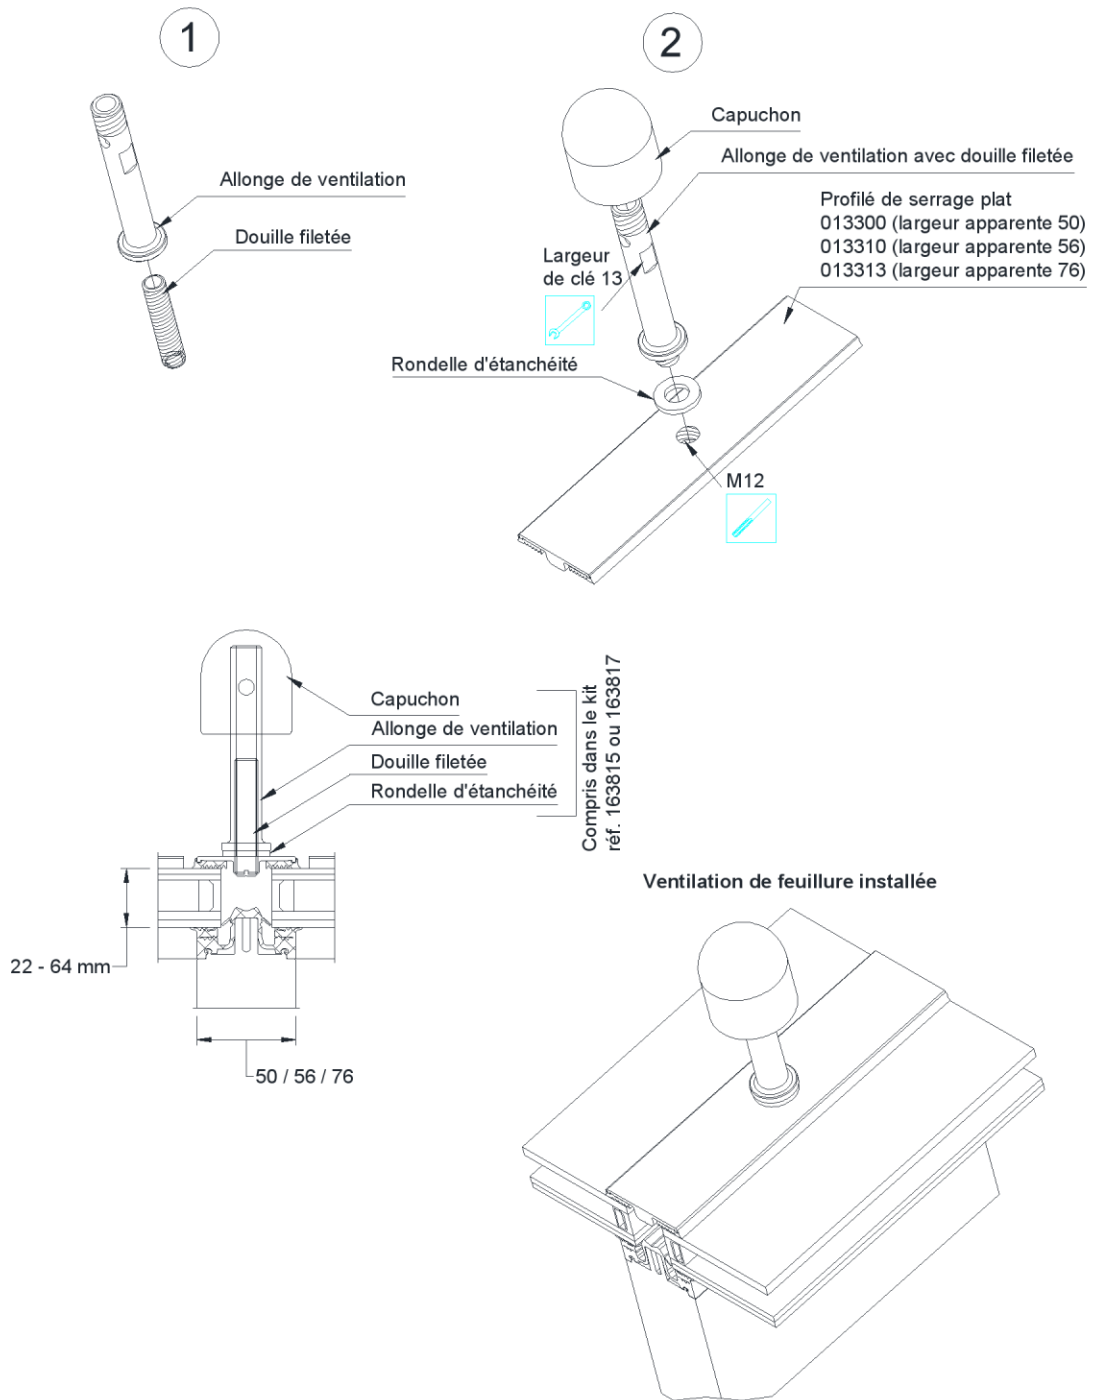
Montage ventilation de toiture dans un profilé de serrage plat
